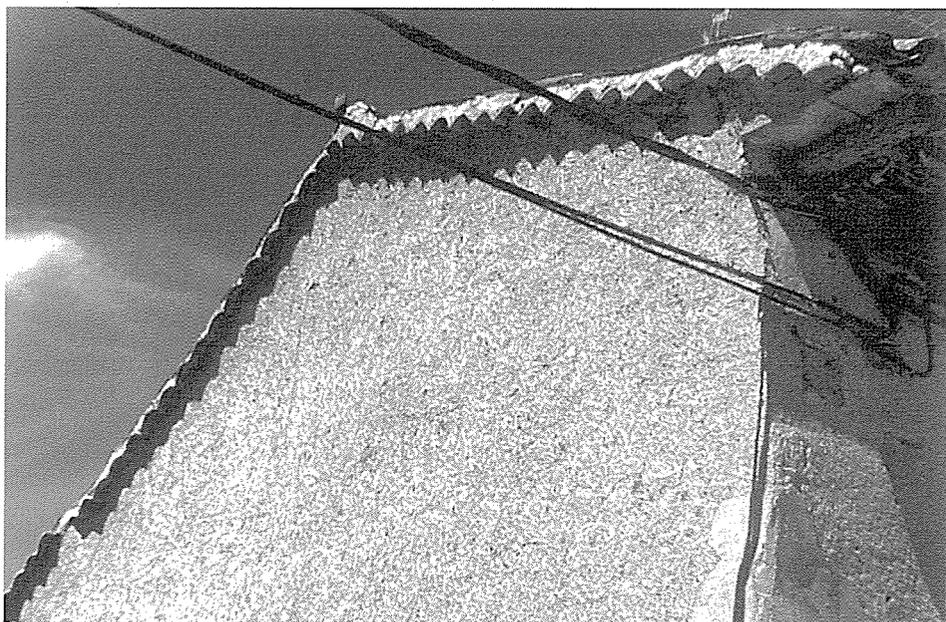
Detalle de trullado en un piñón de cubierta. (Foto del autor)
